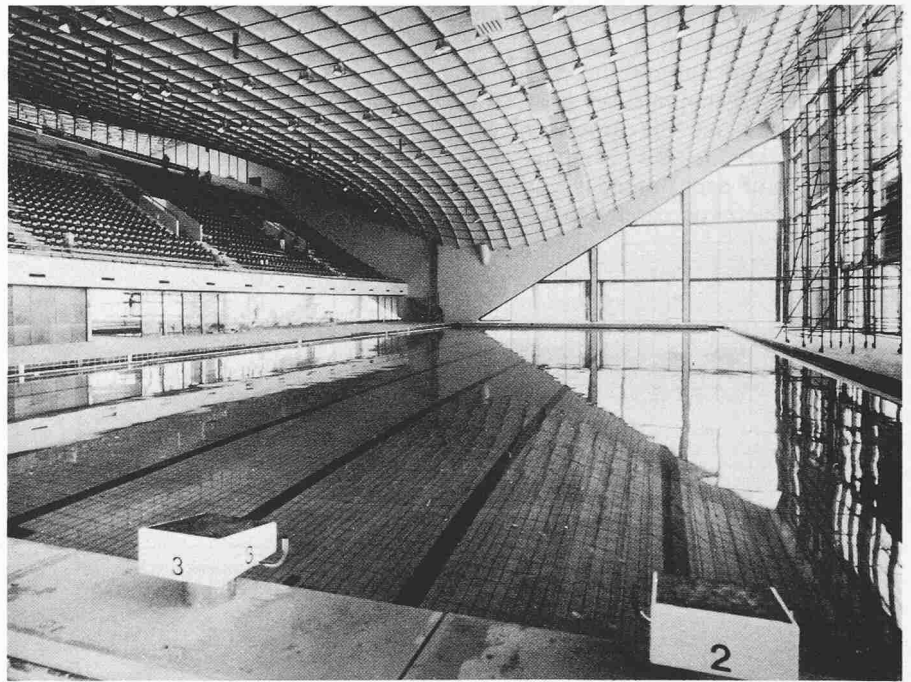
Innenansicht mit dem Olympiabecken 50x21 m
